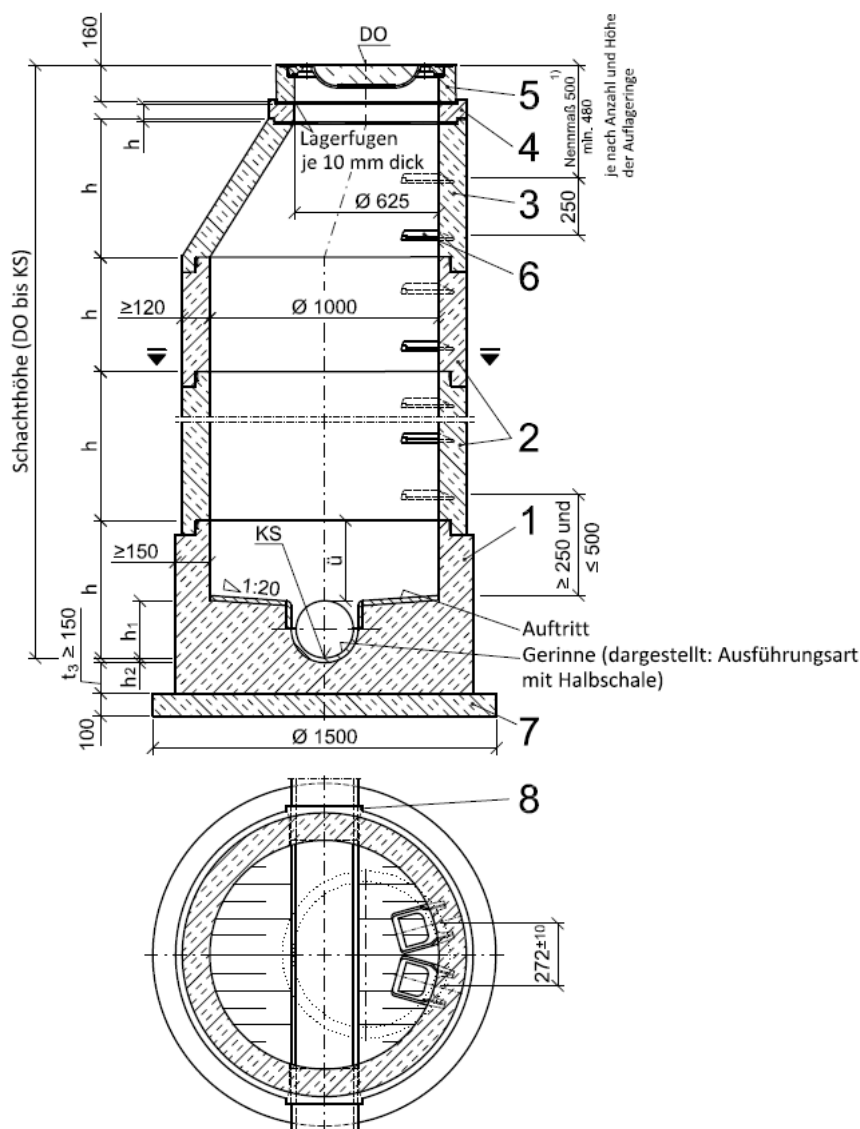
Einsteigschacht DN 1000 aus Beton- und Stahlbetonfertigteilen nach DIN 4034-1
